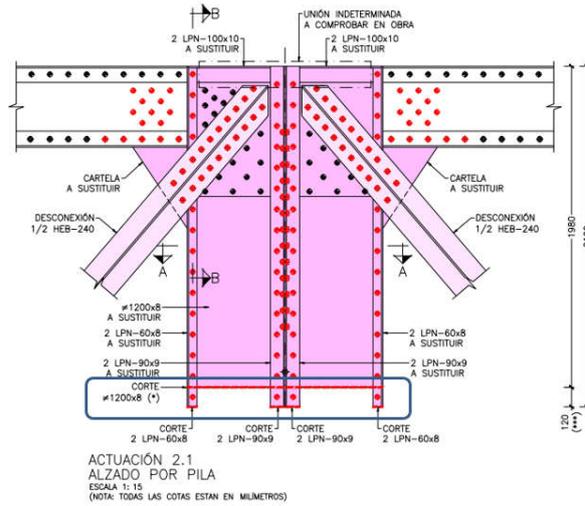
Nudo superior mamparo de pila. Corte chapa de fondo
